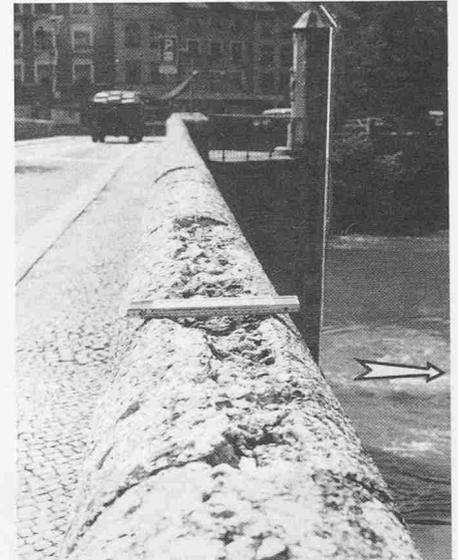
Verwitterte Betonbrüstung. Auf dem Brückenpfeiler: Nepomuksäule von 1911 (markiert)
